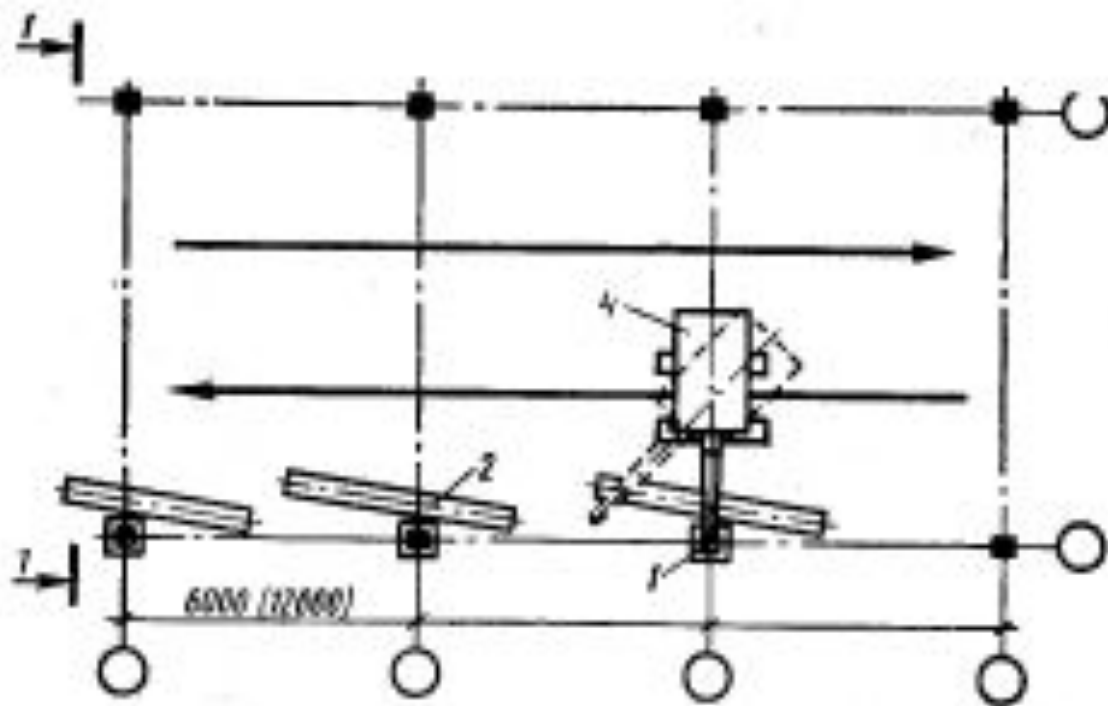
Схема установки колонн в зданиях пролетом 18, 24 и 30 м:
